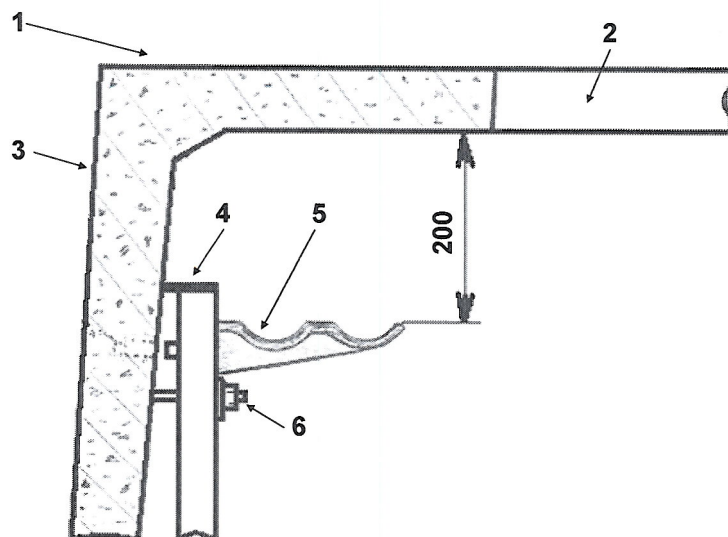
Свободное пространство между перекрытием и верхним рядом консолей ККЧ: 1 – перекрытие колодца типа ККС; 2 – круглое отверстие для люка; 3 – боковая стена верхнего элемента колодца; 4 – кронштейн типа ККП; 5 – консоль ККЧ верхнего ряда; 6 – верхний ёрш с шайбой и гайкой.
